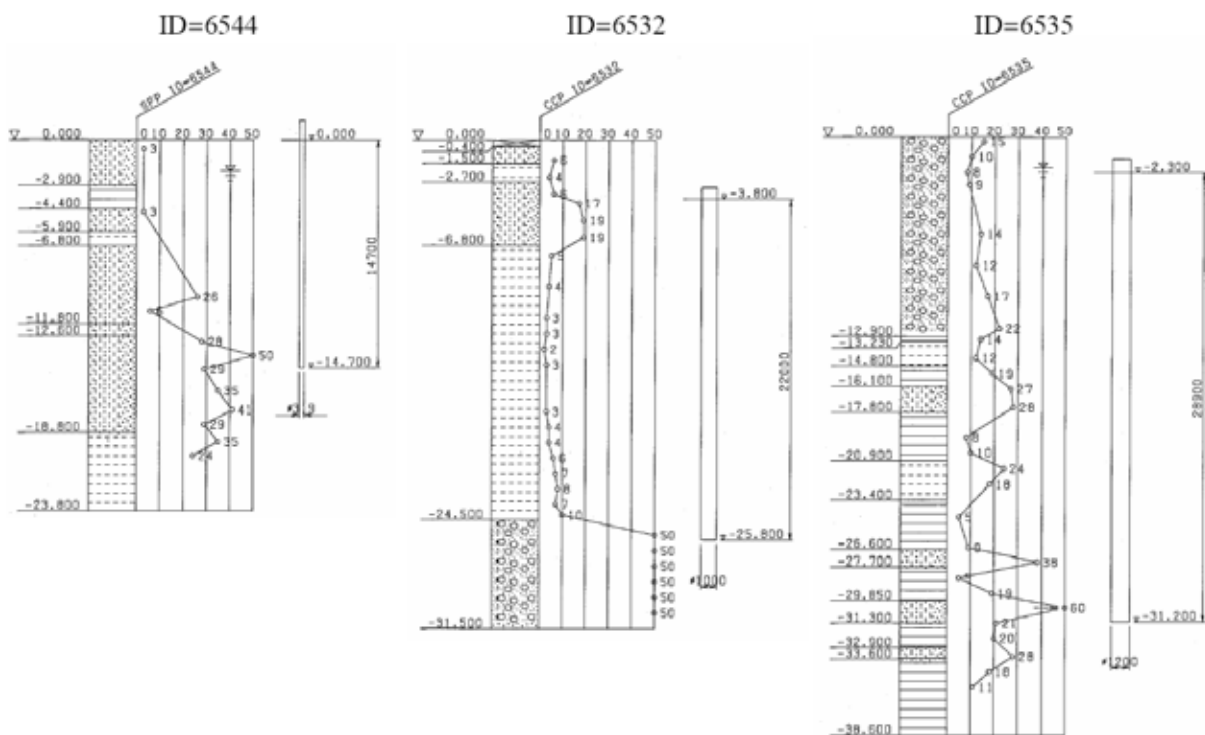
ボーリング柱状図 (組杭 単位: mm)
